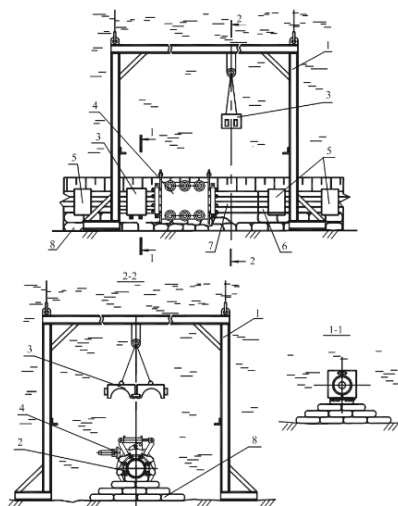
Схема восстановления балластировки на отремонтированном трубопроводе
